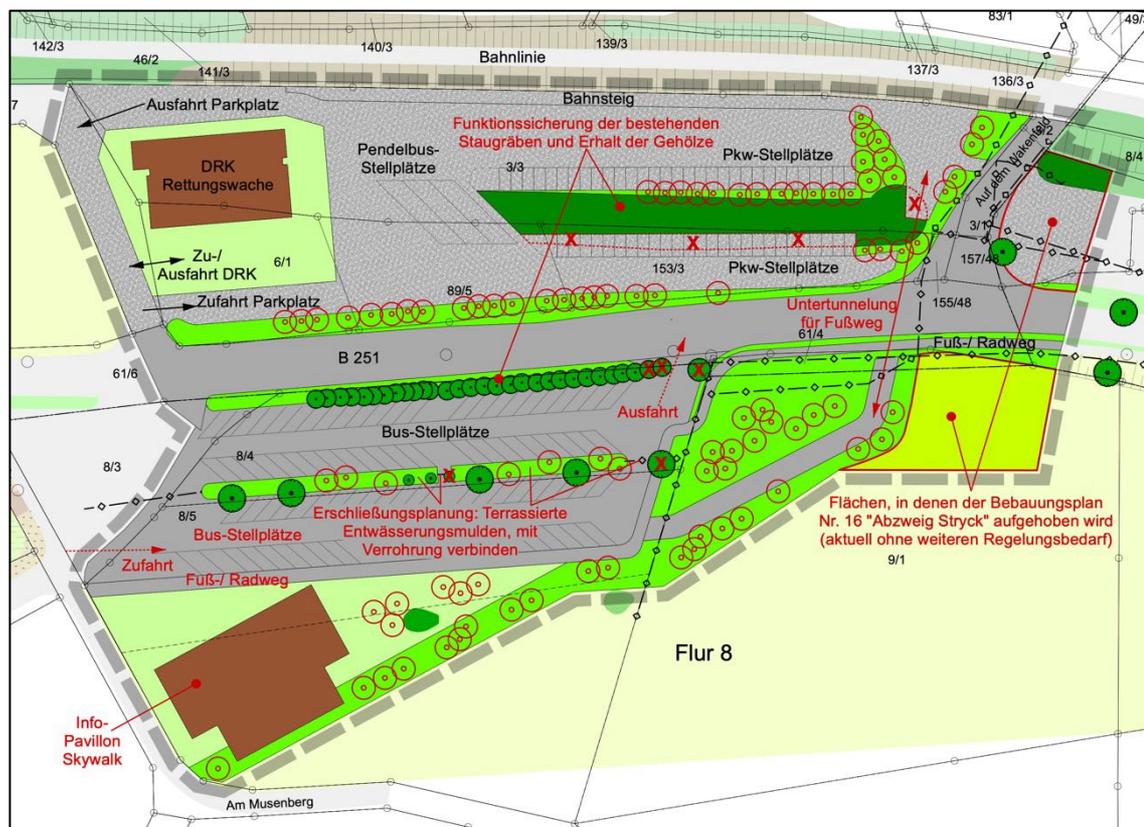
Lageplan - Ausschnitt Grünordnungskonzept (rot: geplant, schwarz: bestehend)
